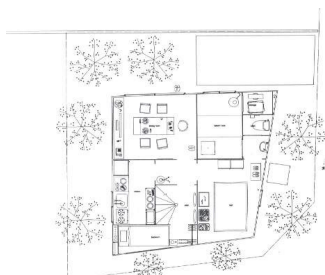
Planta situación. Casa en un huerto de ciruelos, Tokio, 2003. Sanaa
